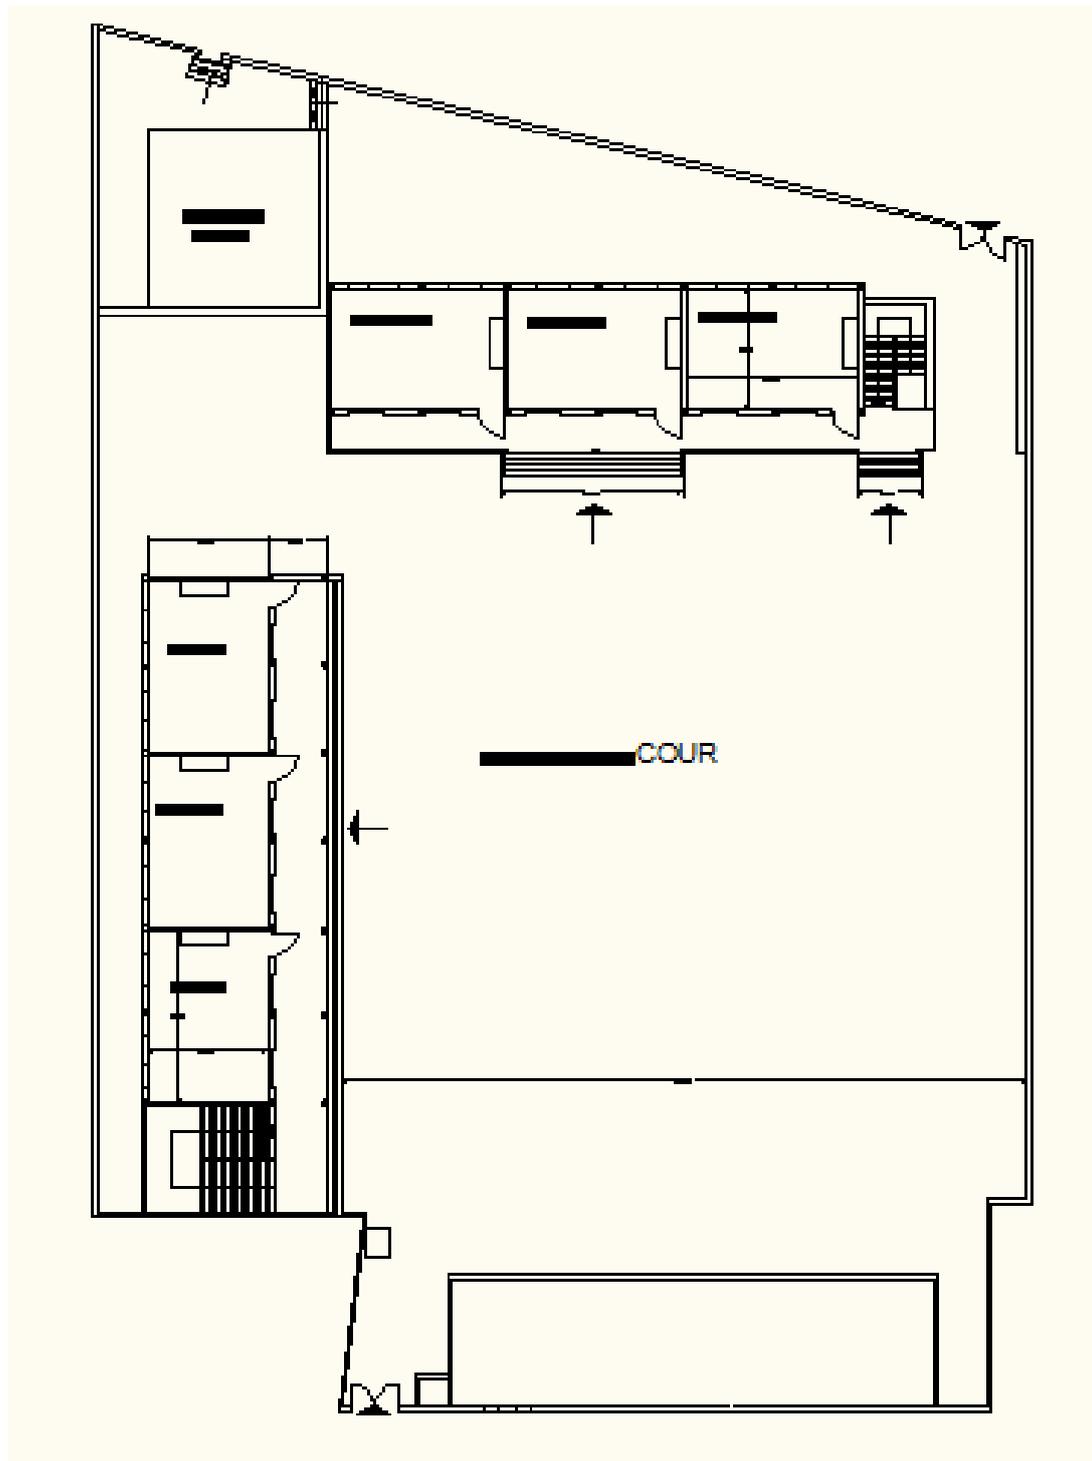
Plan de l'étage de l'école Ibn Baytar
